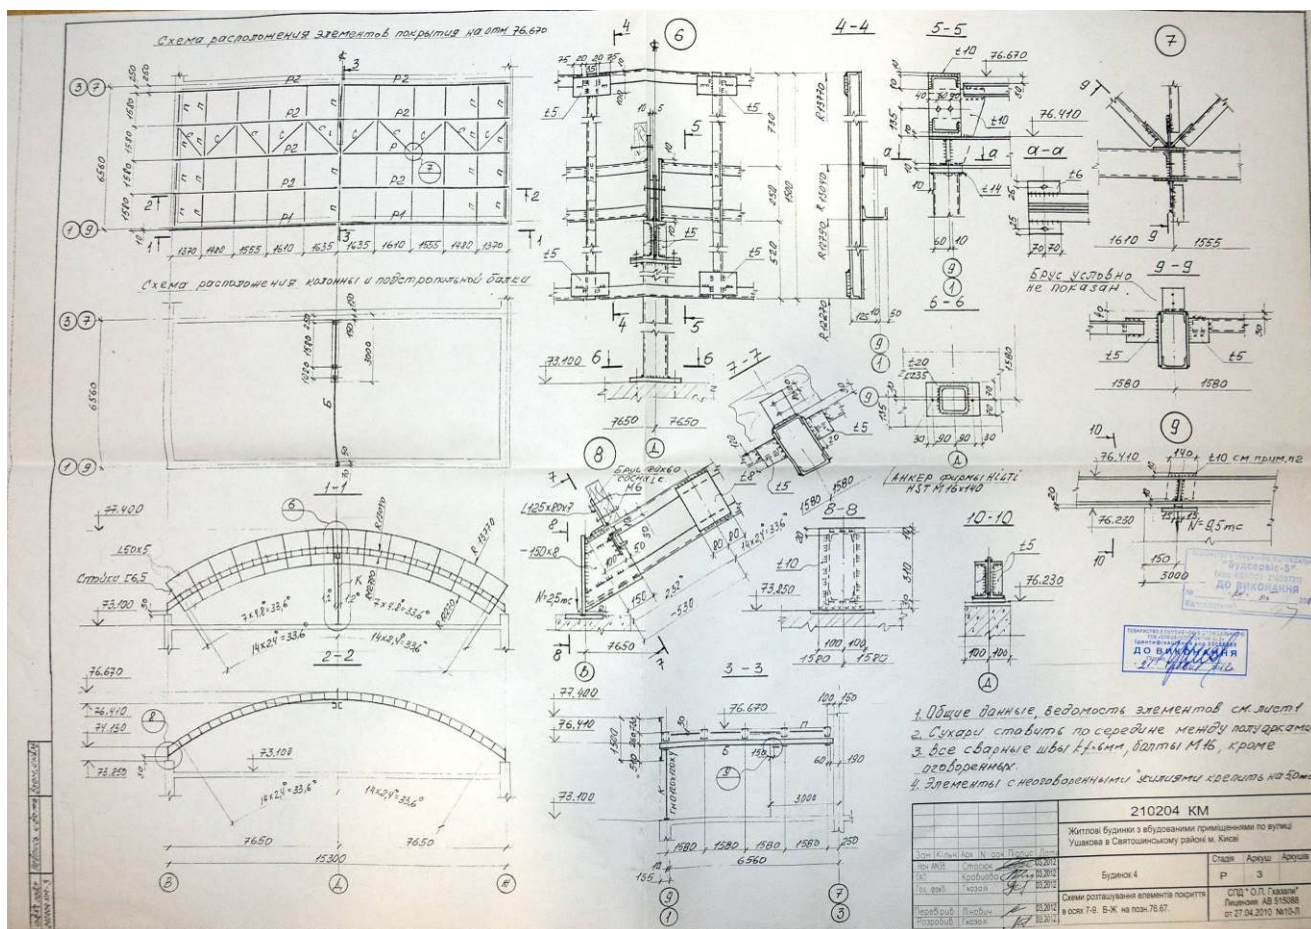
Проектна документація на влаштування покрівлі над горищем квартири.
